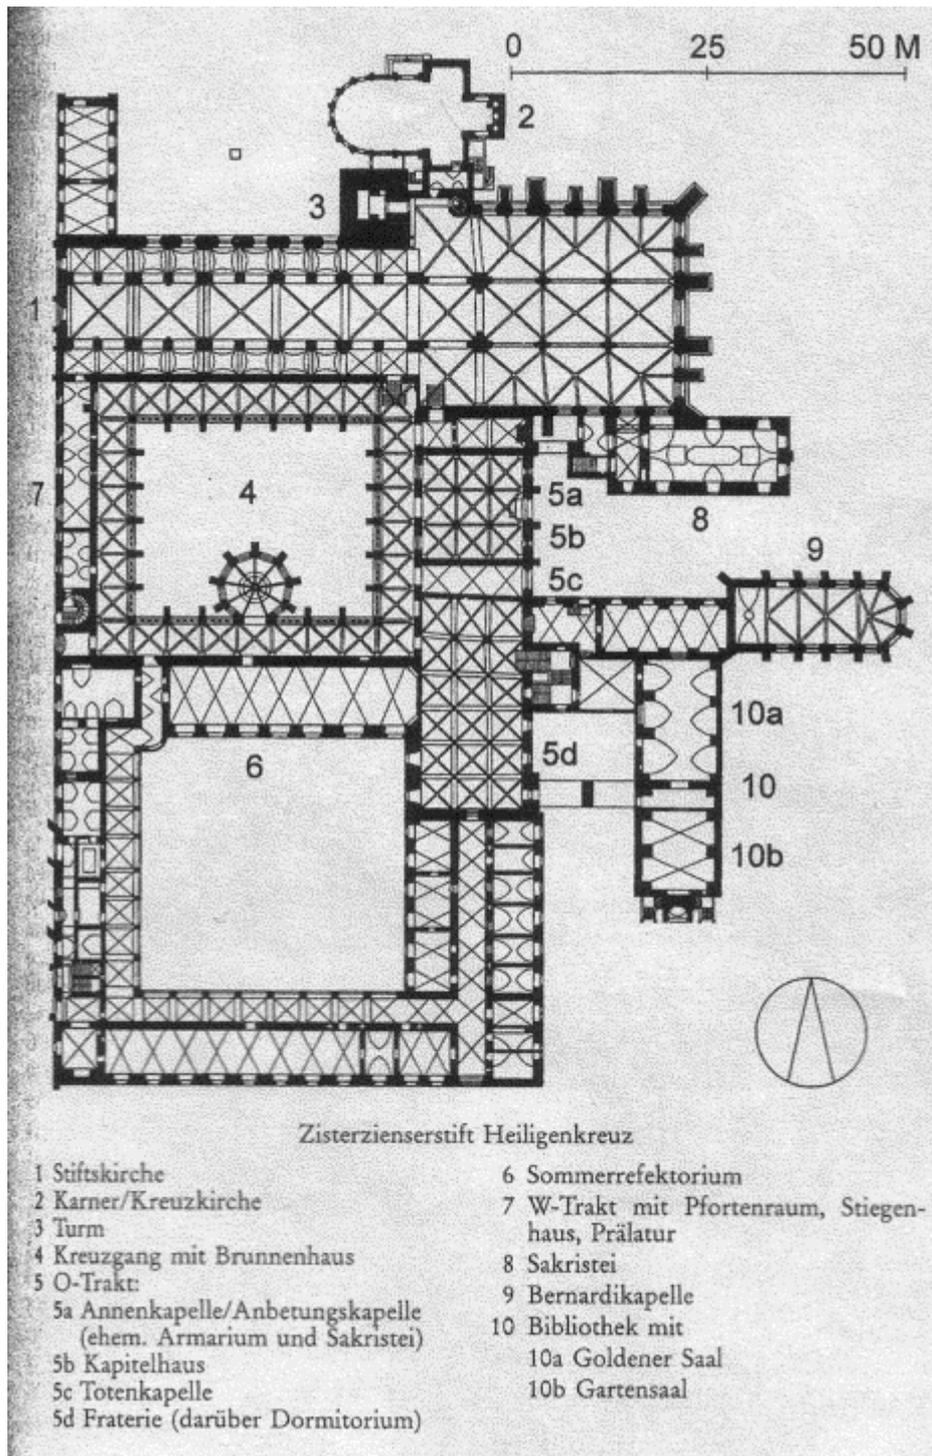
Heiligenkreuz, Zisterzienserstift Heiligenkreuz, Grundriss, Ausschnitt
